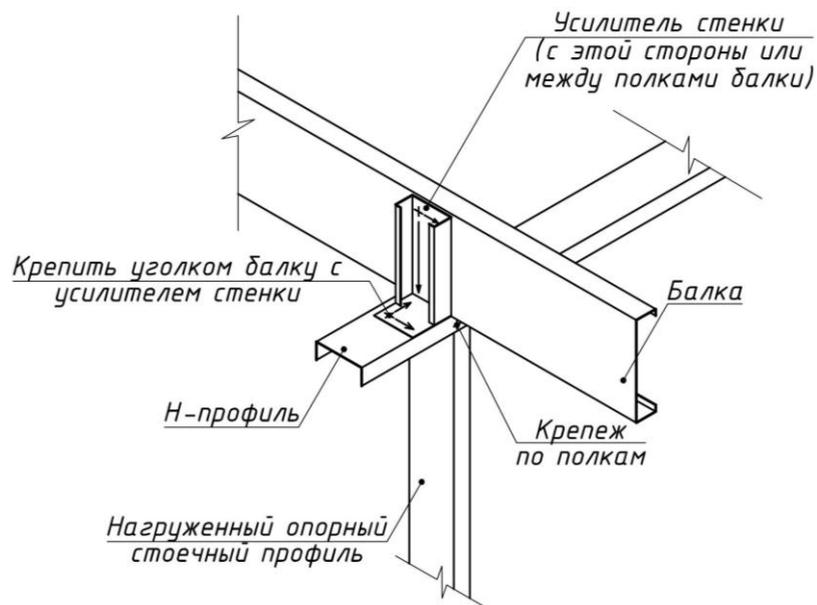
Узел П 7. Крепление сплошной балки
